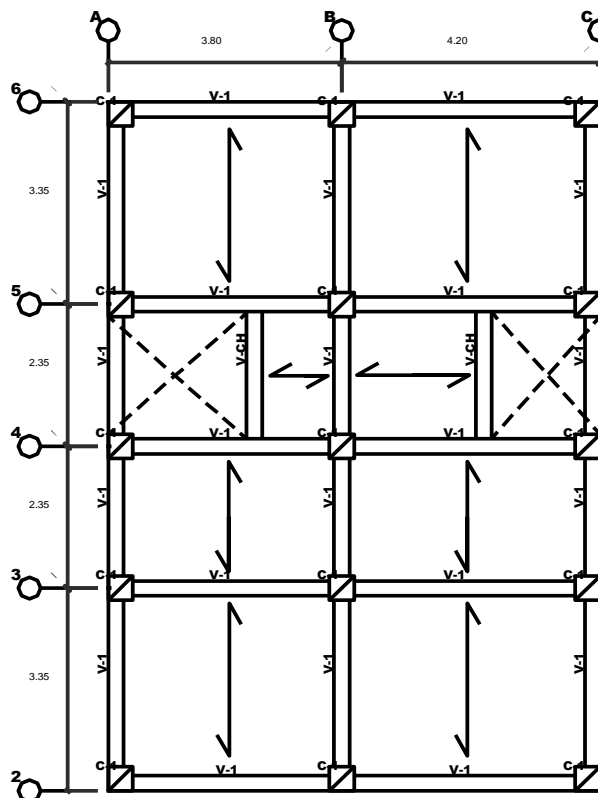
Estructuración de proyecto empleando VIGACERO. Elaboración propia.
